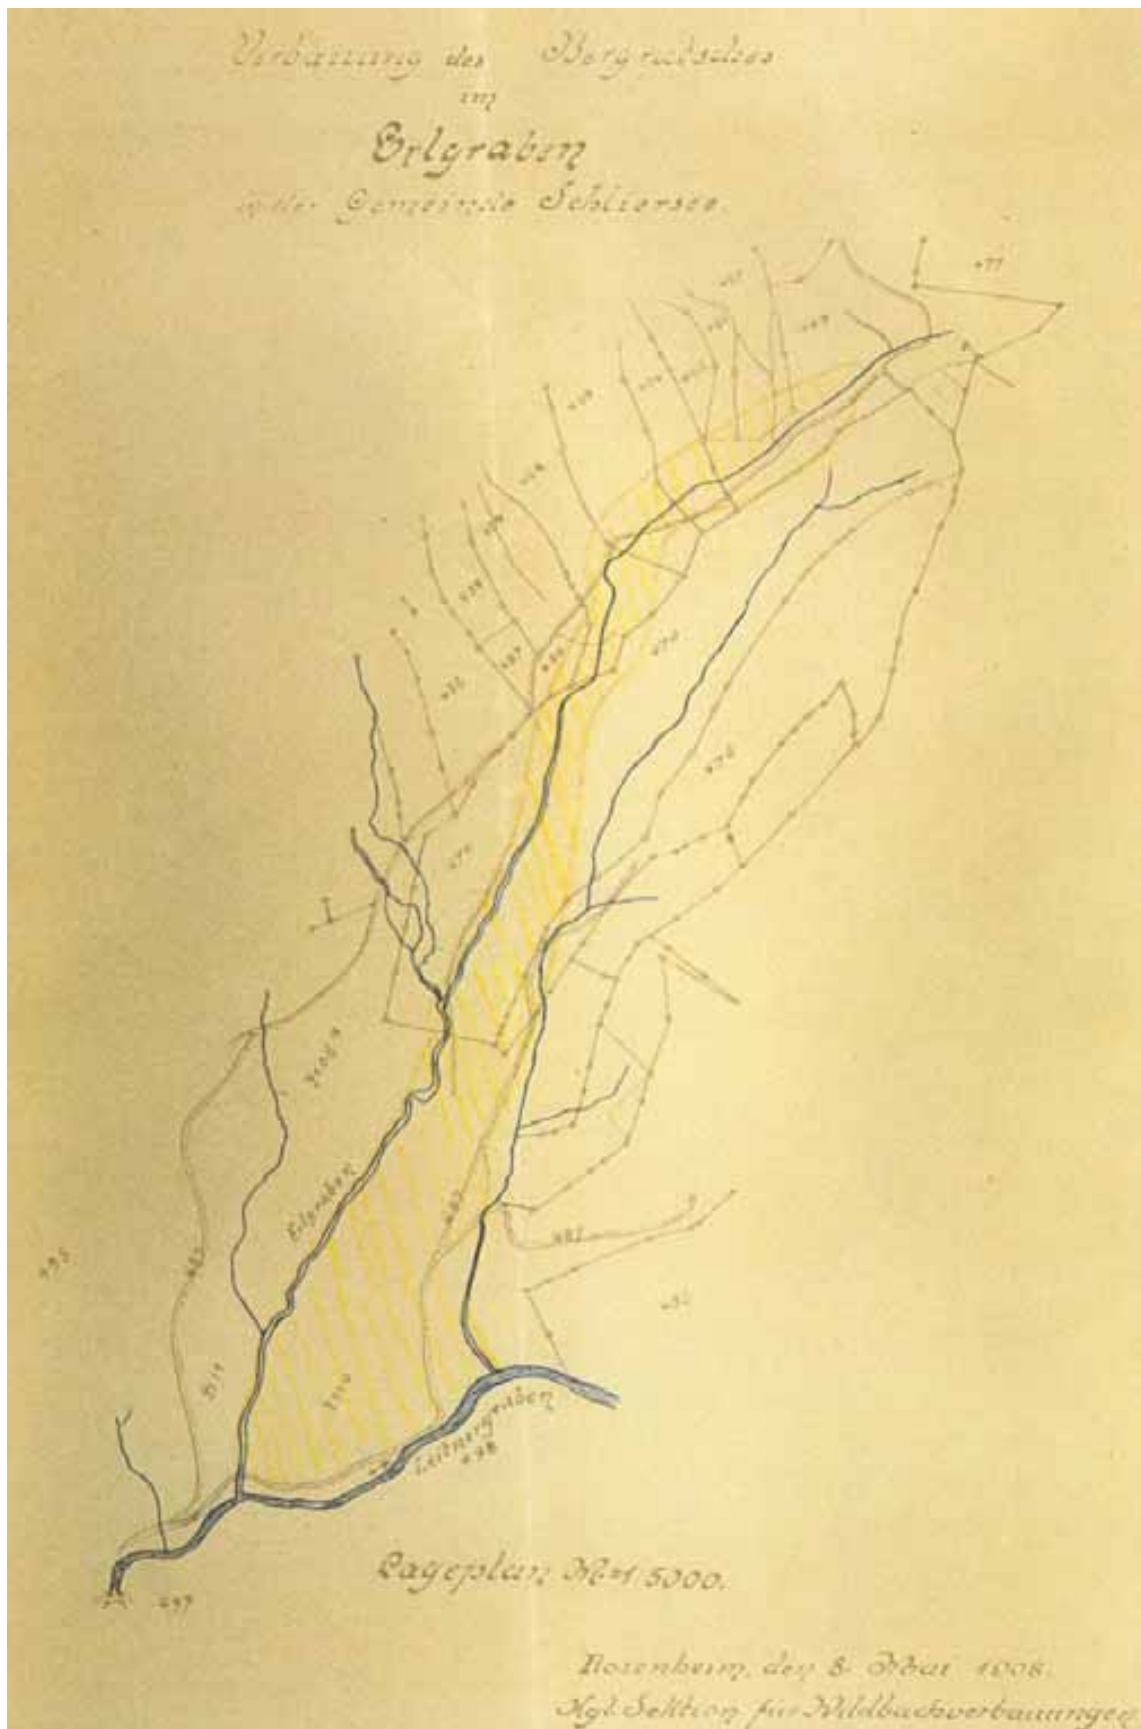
Lageplan einer Rutschung am Erlmoosgraben (Schliersee) im Jahr 1908
